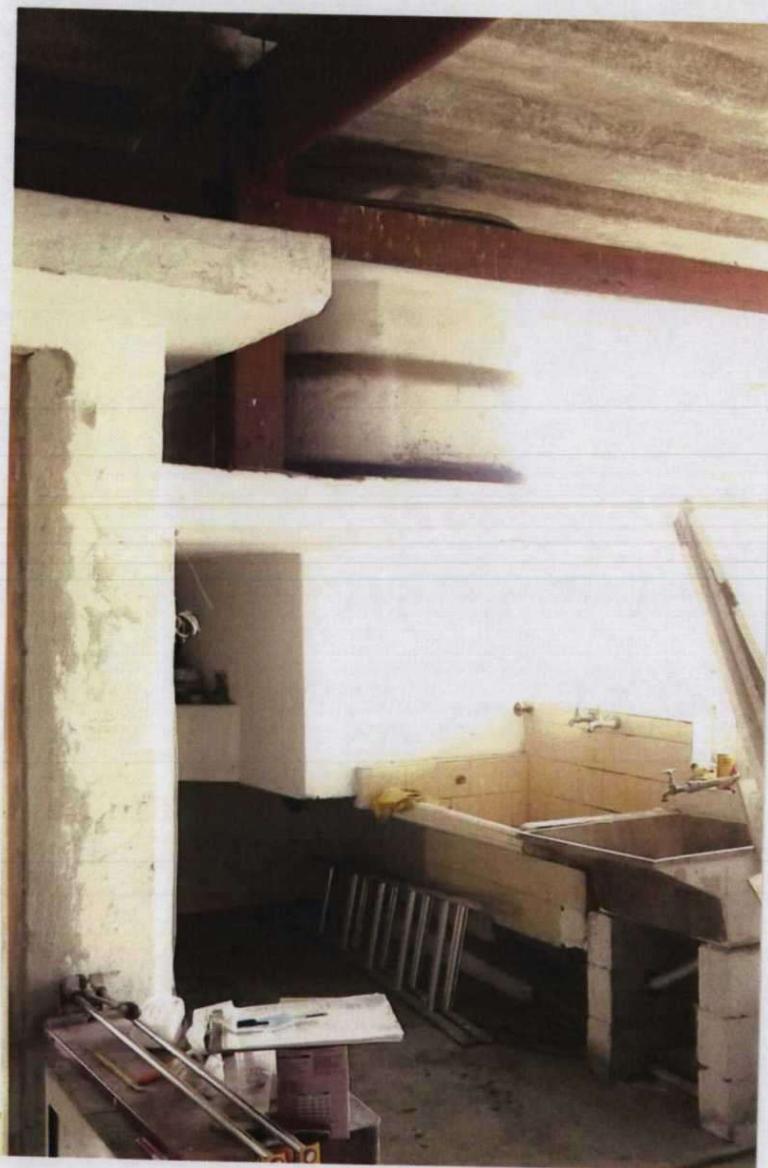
ESTRUTURA DE SUPORTE A CAIXA D'ÁGUA ; TANQUES
